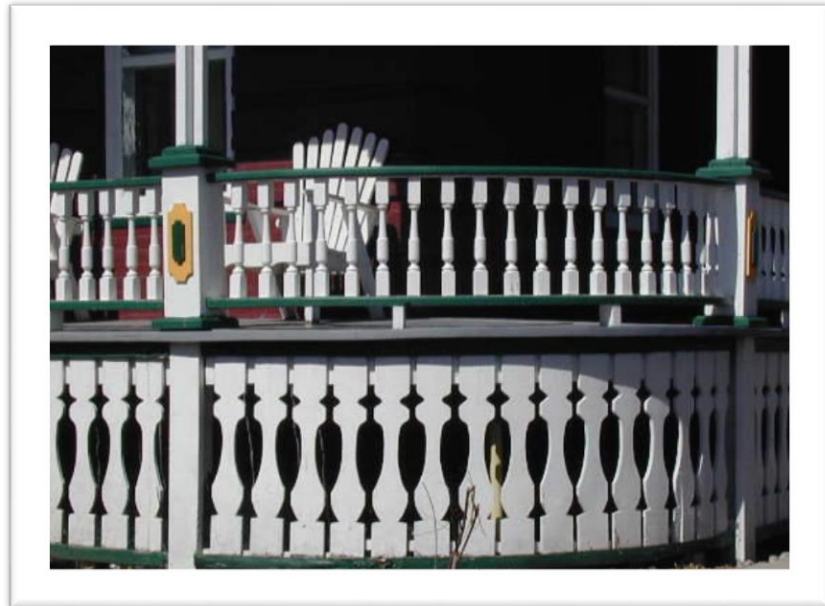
Jupe fabriquée à partir d'un assemblage de planches au découpage complexe et imitant des balustres de poteaux tournés de balustrade. Justement, cet assemblage s'avère trop élaboré par rapport à la balustrade de la galerie, ce qui contribue à rendre trop massif l'ensemble de la galerie.
